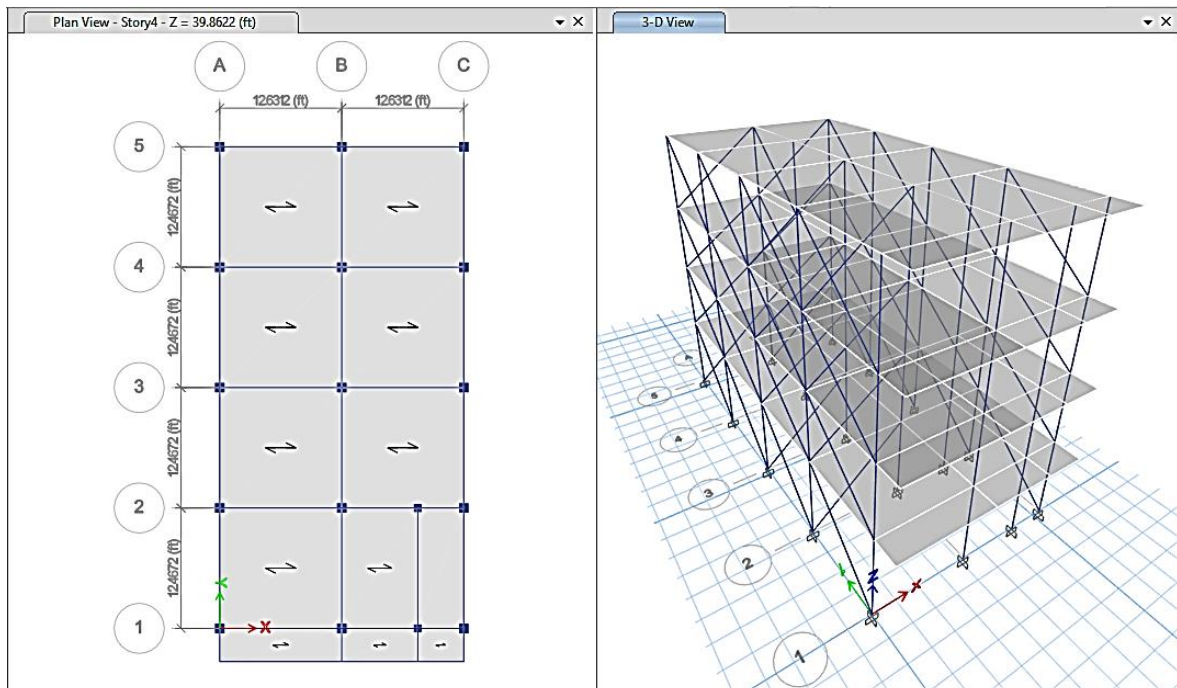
Modelo de vista en planta y 3D de la estructura. Fuente (elaboración propia del investigador).
